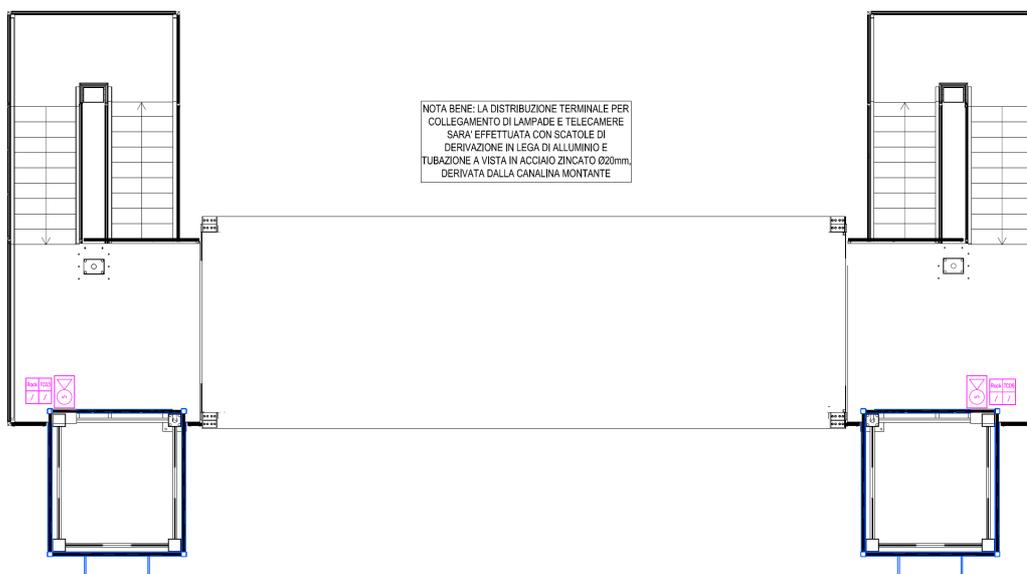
Estratto impianto tvcc planimetria piano ammezzato
